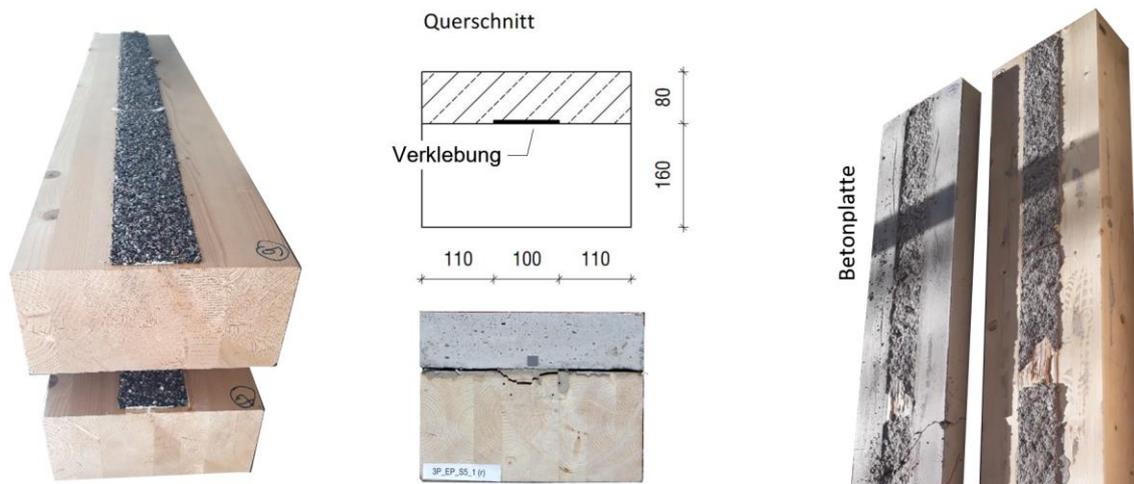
Kurze Biegeträger mit schmaler Fuge: Links: Vor dem Betonieren. Rechts: Nach den Versuchen mit Beton- und Holzversagen. Das Bild zeigt vorwiegend Betonversagen
